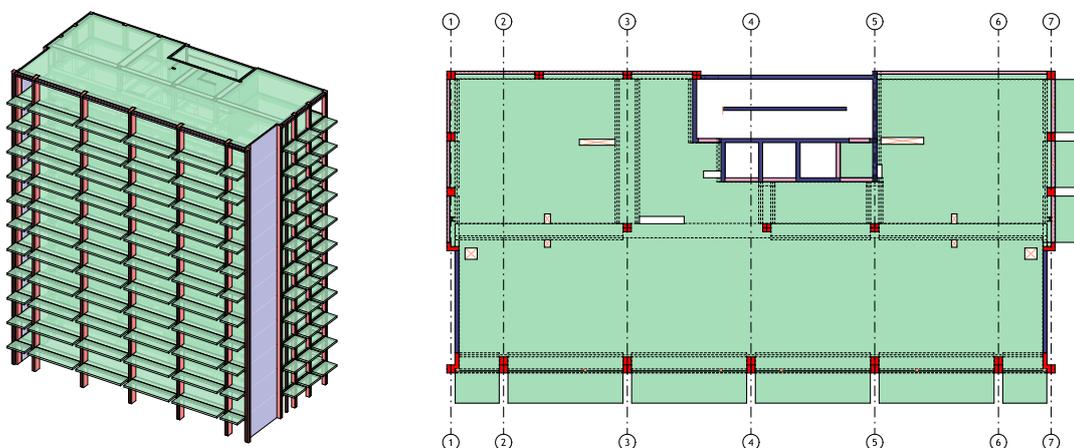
Modelo tridimensional e planta do piso da estrutura do edifício
